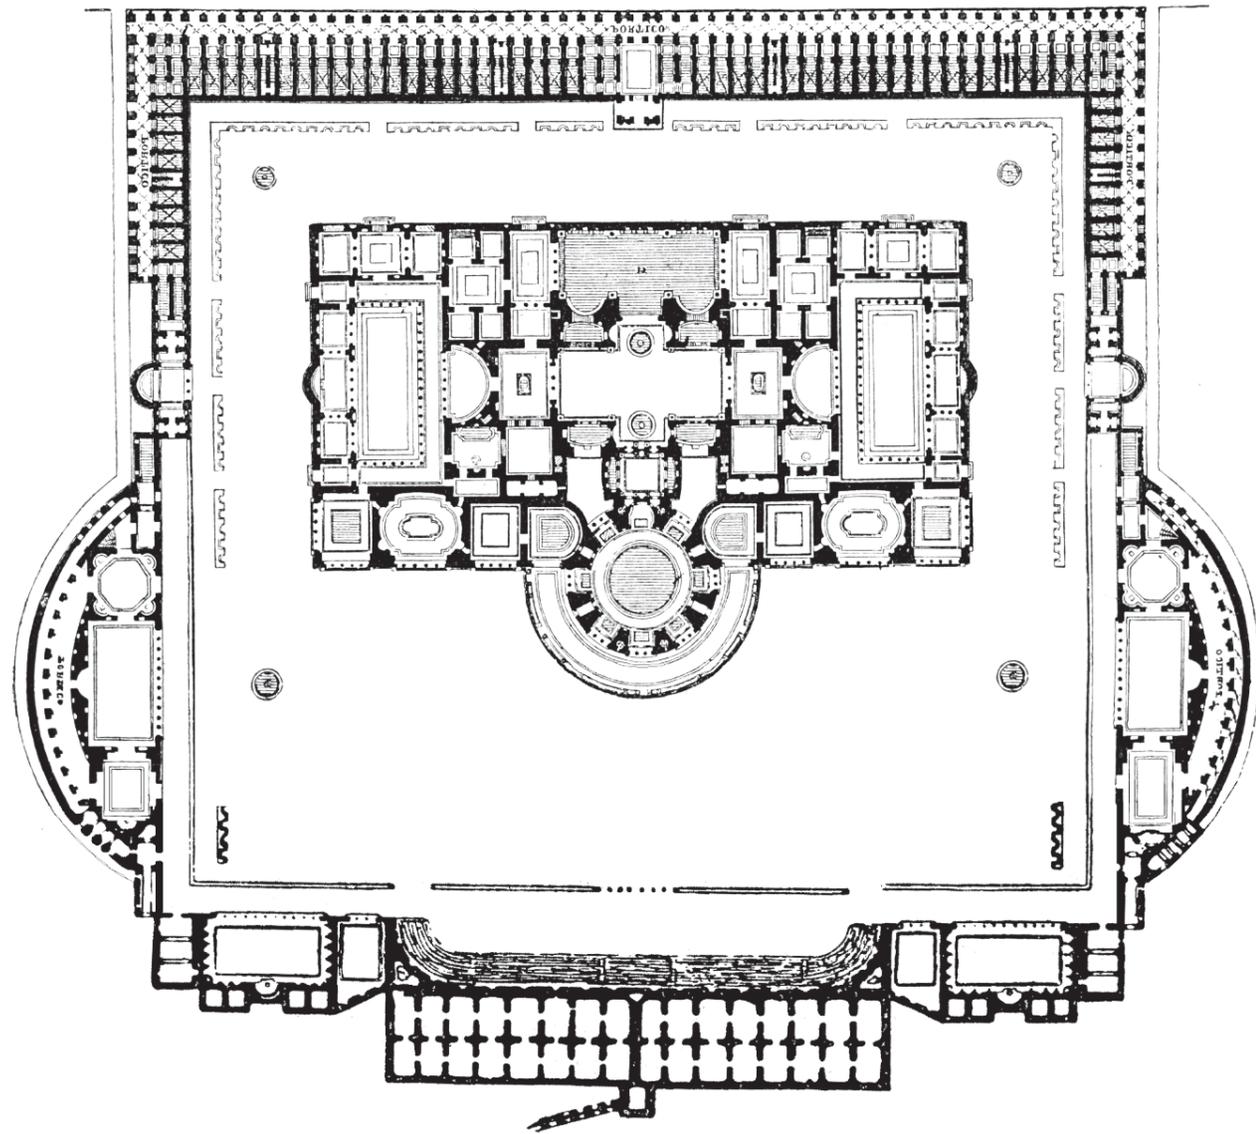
Grundriss der Caracalla-Thermen
